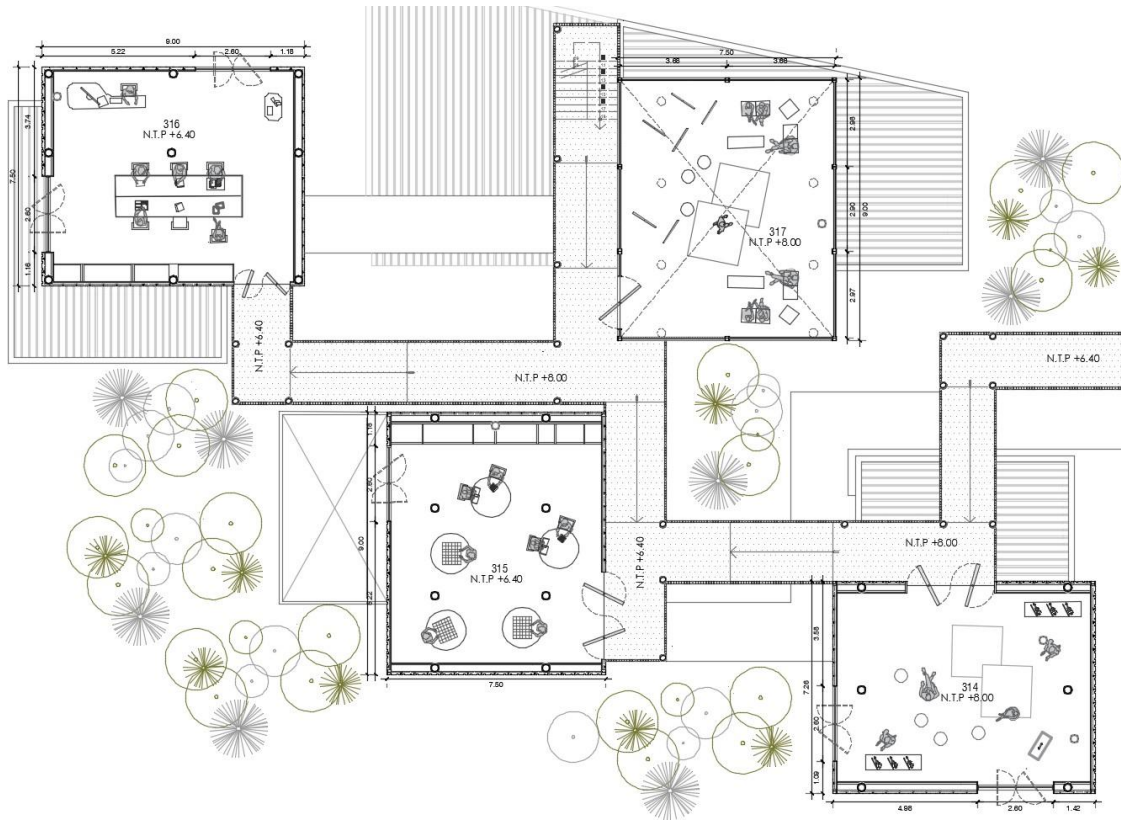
Rampas y escaleras de acceso. Elaboración propia (2020)
